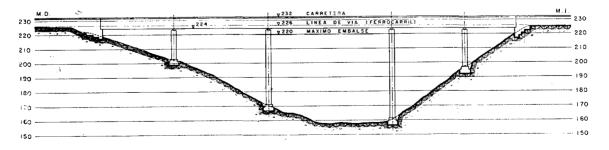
Puente mixto de Alconetar. (Alconetar bridge).
